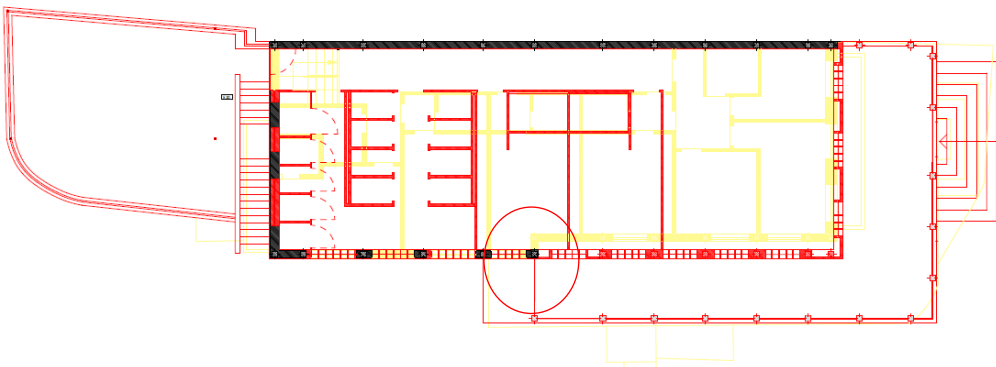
ALTERAÇÕES | PLANTA DO PISO 1 | S/ESCALA
